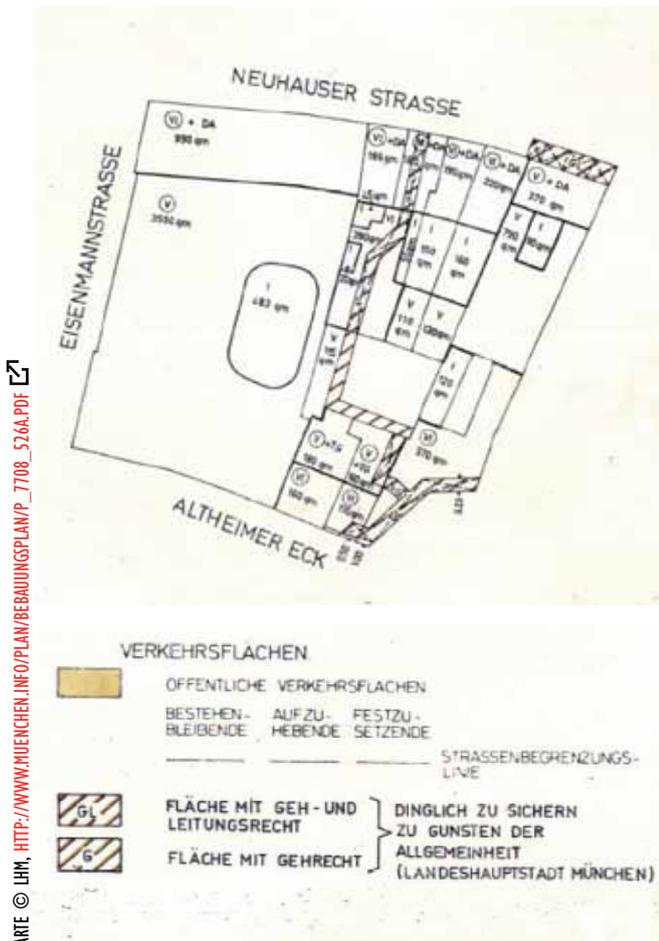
Bebauungsplan Nr. 526a: Altheimer Eck 8-16, Eisenmannstraße, Neuhauser Straße 5-13 – Plan 3 : Maß der baulichen Nutzung, Arkaden, Durchgang, dinglich zu sichernde Flächen
